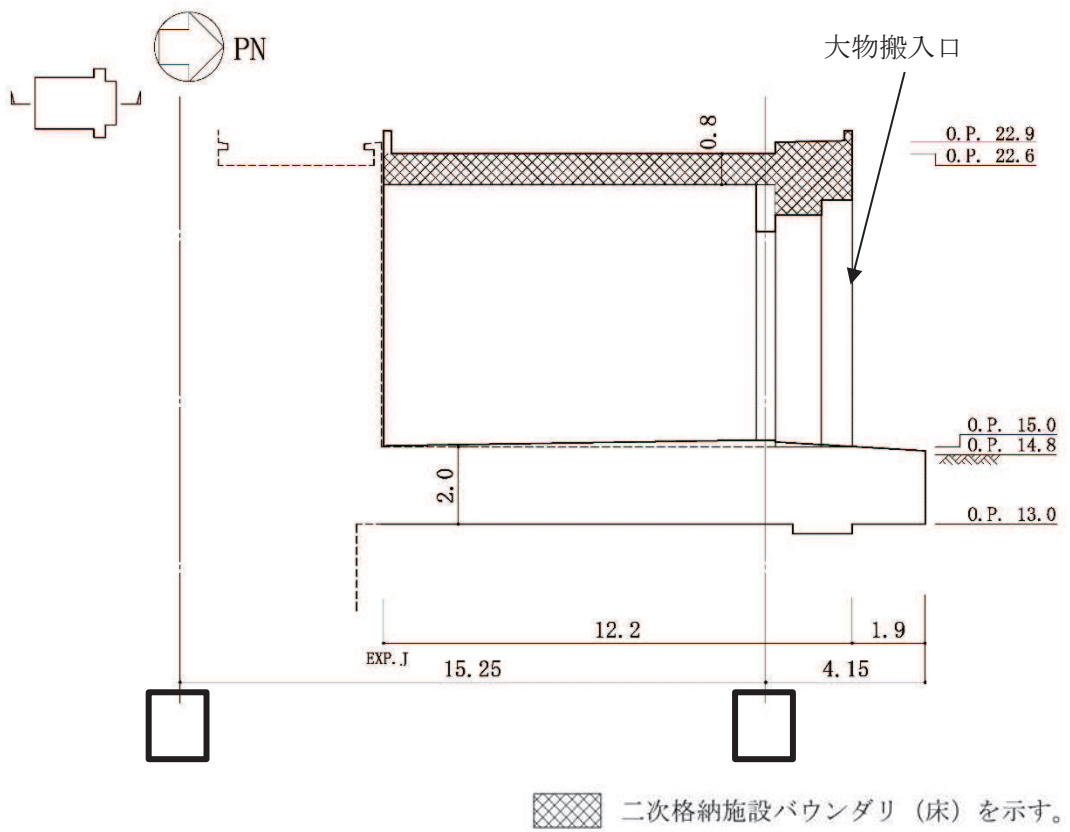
(2) 原子炉建屋原子炉棟（二次格納施設）の範囲の平面図
